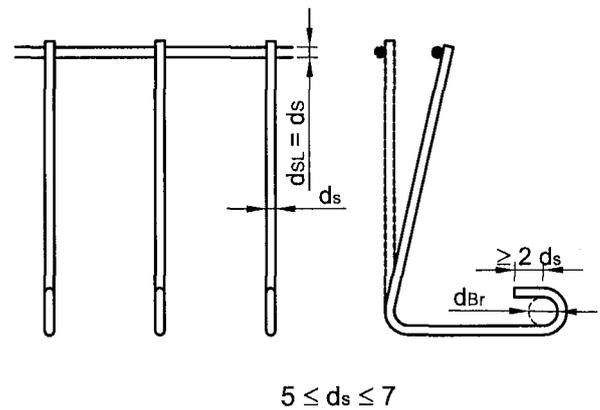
D-Träger mit Betonfußleiste und einschnittigen Bügel
